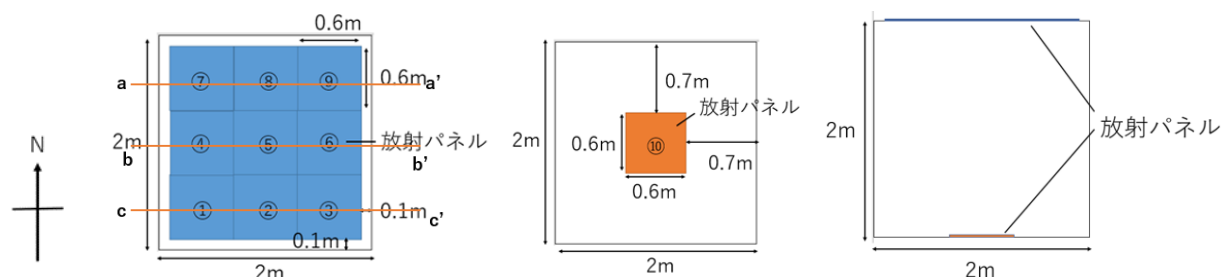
形状モデル (左: 天井面の平面図、中央: 床面の平面図、右: 立面図)
